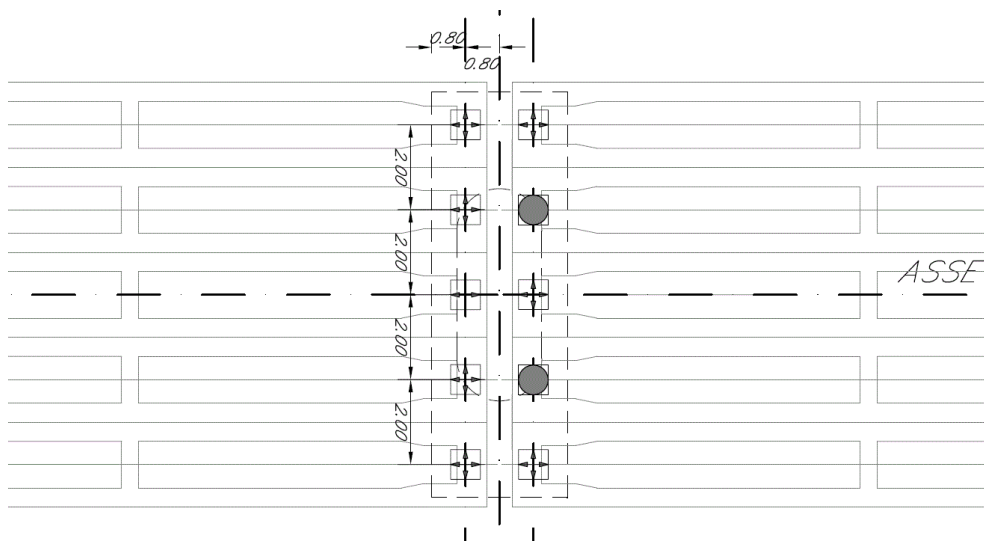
Pila 1 - Schema dei dispositivi di appoggio
